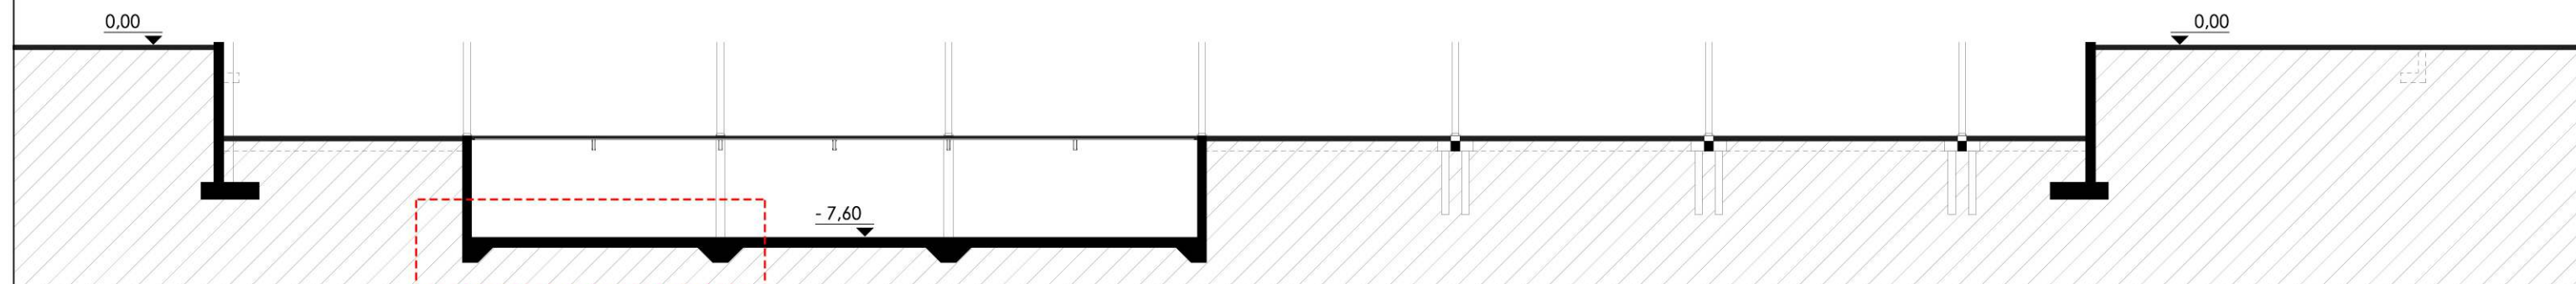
PLATEA CON CAPITELES INFERIORES (COLUMNA) ESC. 1:50
